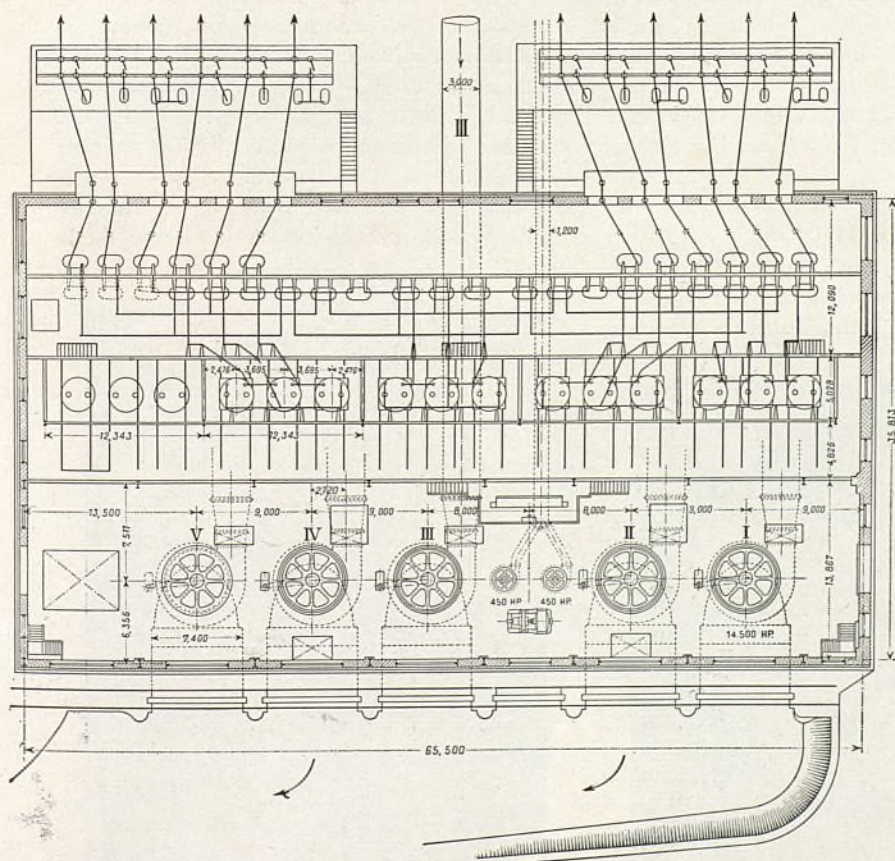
Planta de la casa de máquinas de la Central de Serós.—Escala 1 : 600.
